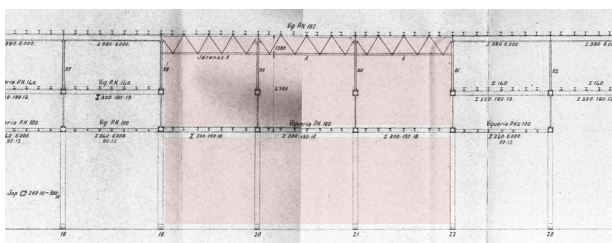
Sección longitudinal del Gimnasio Maravillas. Se observan los pórticos con cerchas Tipo Warren y los espacios proporcionados de ambas plantas
